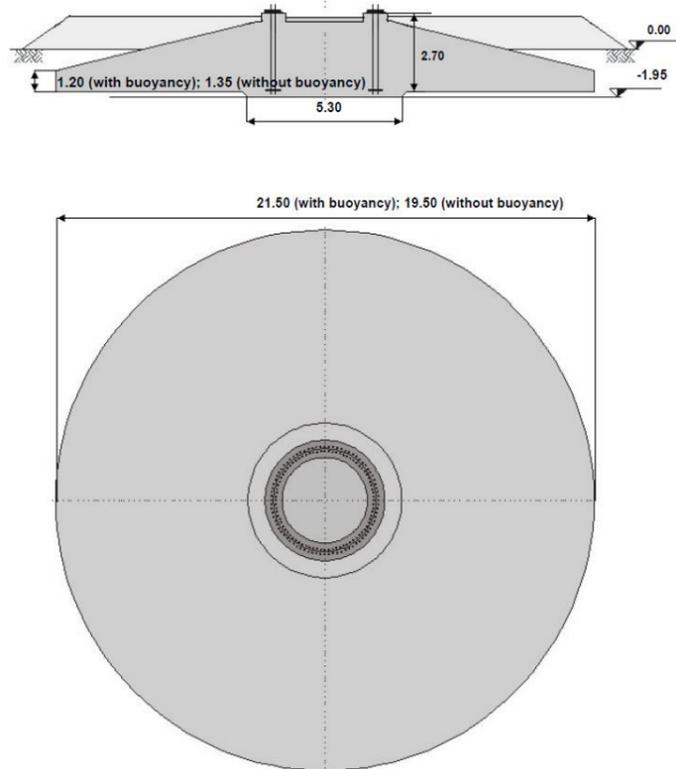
Plans des fondations de l'éolienne N131 - 3MW - 165m (Source : NORDEX)
